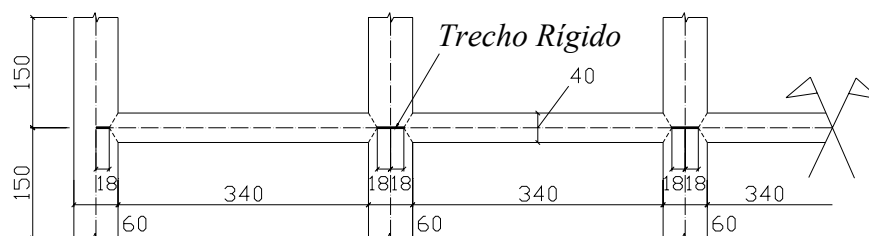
Geometria da viga, Caso 10 (dimensões em cm)
